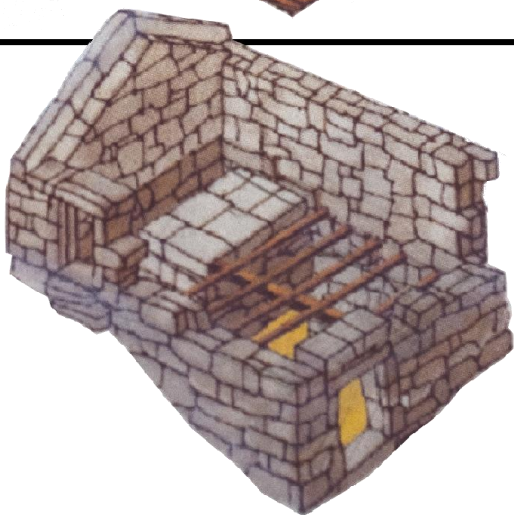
Sistema construtivo da Casa Florestal – semelhante ao sistema da Casa Rural.
